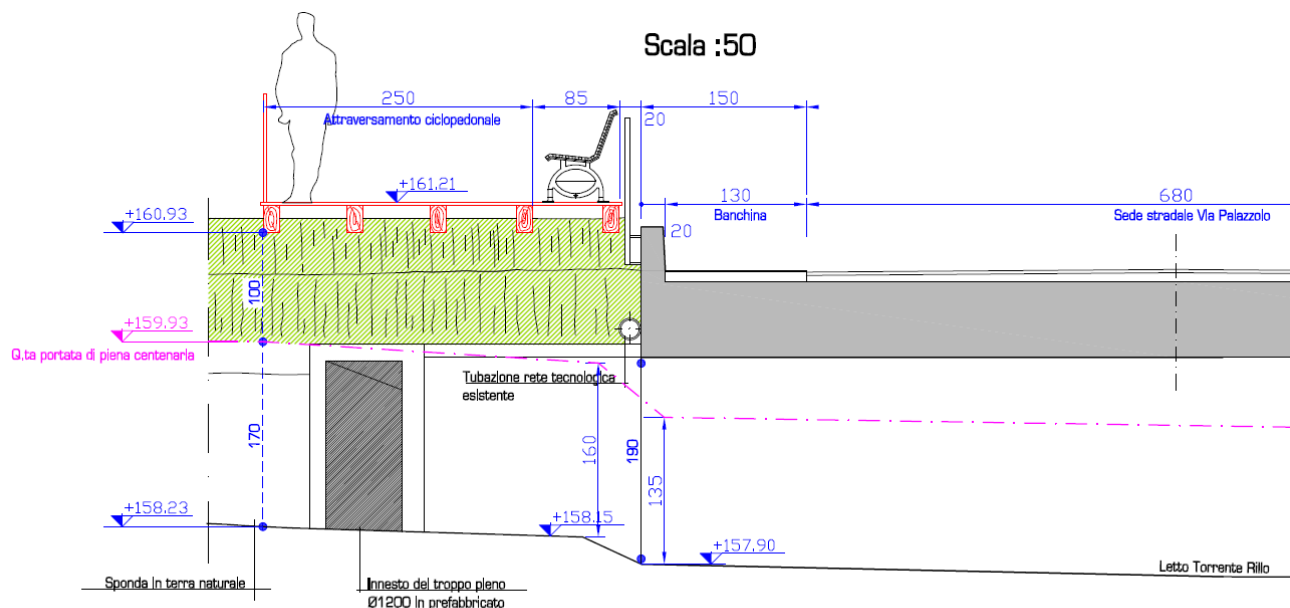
Sezione di progetto intervento di "Realizzazione di complesso residenziale – attraversamento Torrente Rillo con passerella in via Palazzolo" (14/02/2019).
